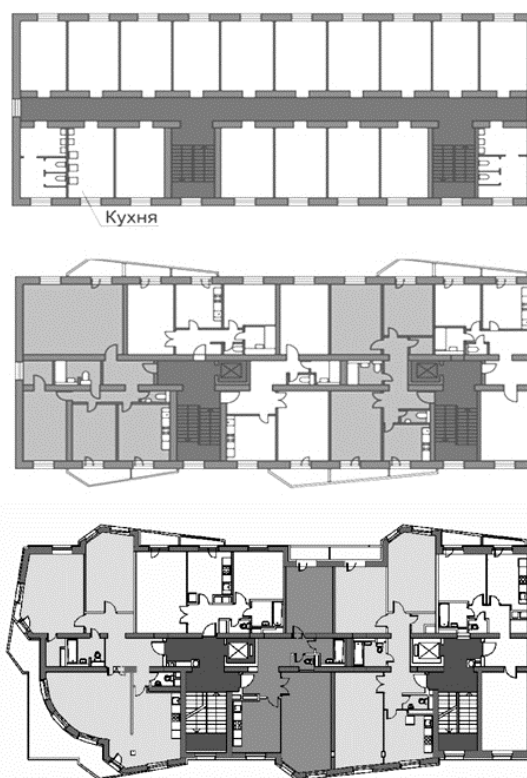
Планы типового этажа общежития в Самотечном переулке в г. Москва до и после перестройки, план надстроенного этажа
